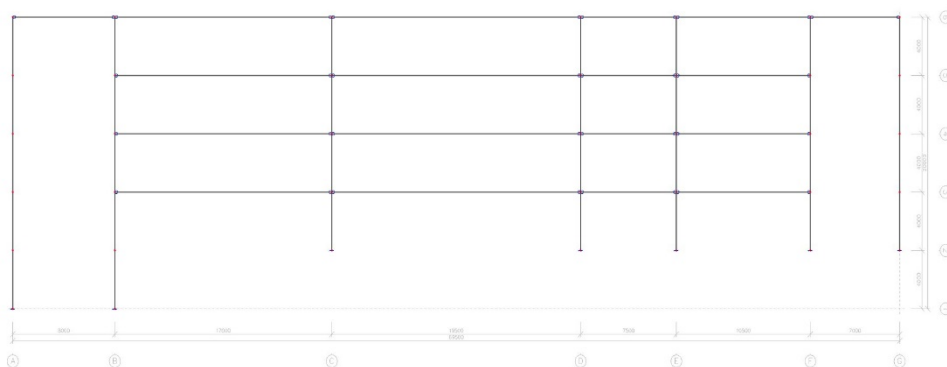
Varianta II. -Konstrukční řešení 2.NP
